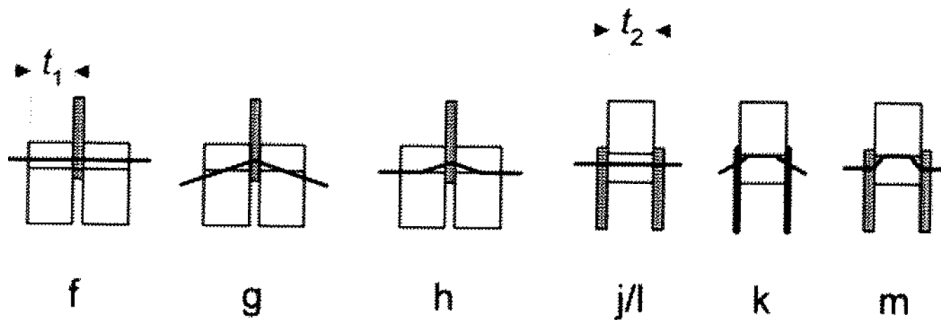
Versagensmechanismen für zweischnittige Stahlblech-Holz-Verbindungen
